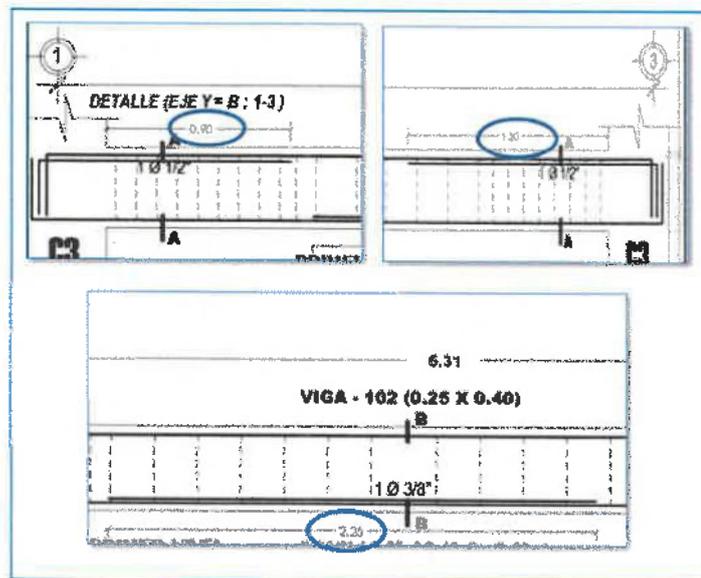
Detalle de acero de refuerzo en viga, según expediente.
